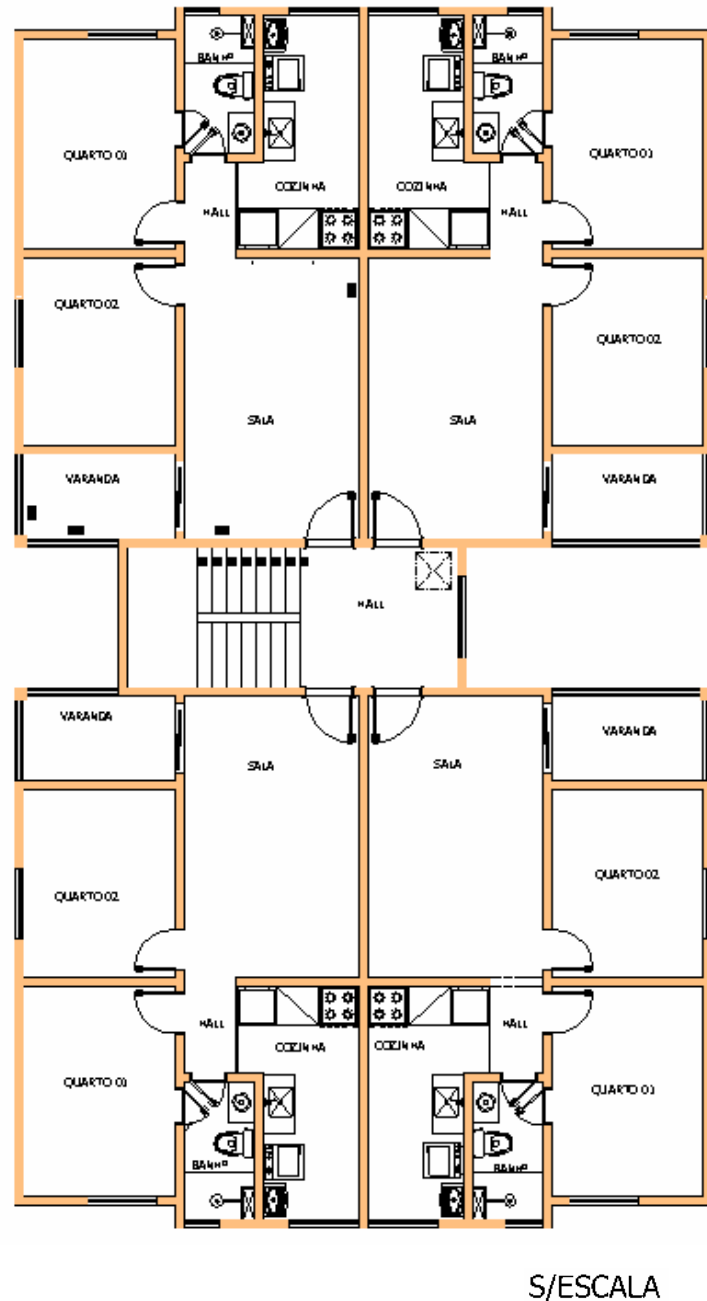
Planta Baixa ilustrativa do Pavimento Tipo
